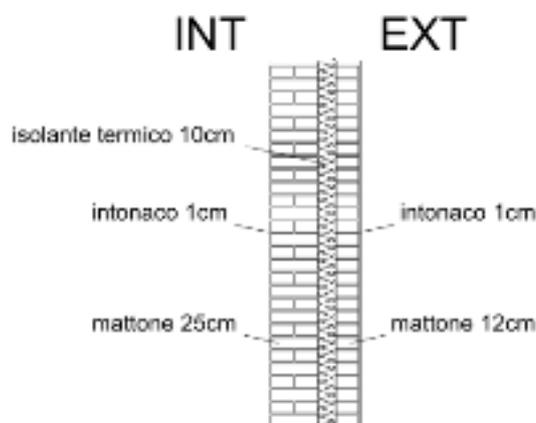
Sezione muratura a seguito dell'insufflaggio
